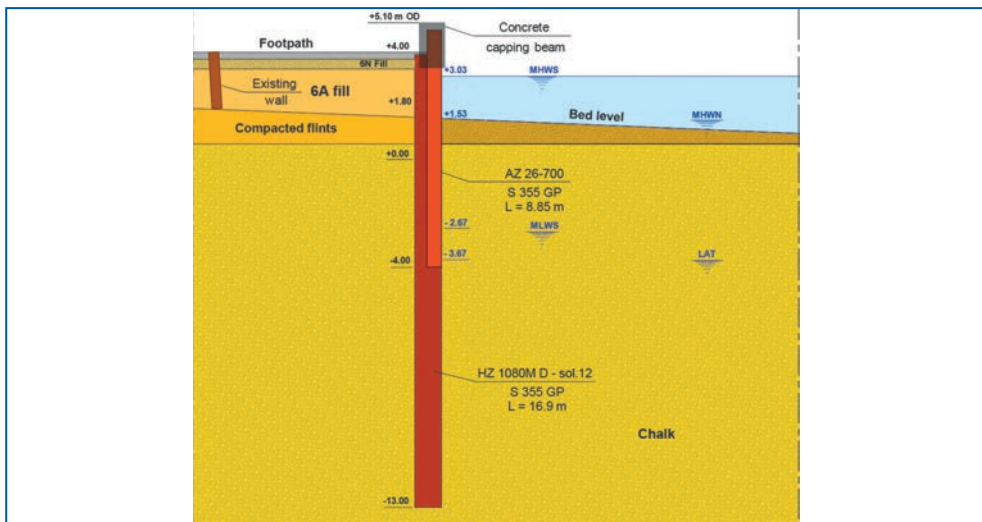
Sección Tipo E1. Fuente: ArcelorMittal (2019)
